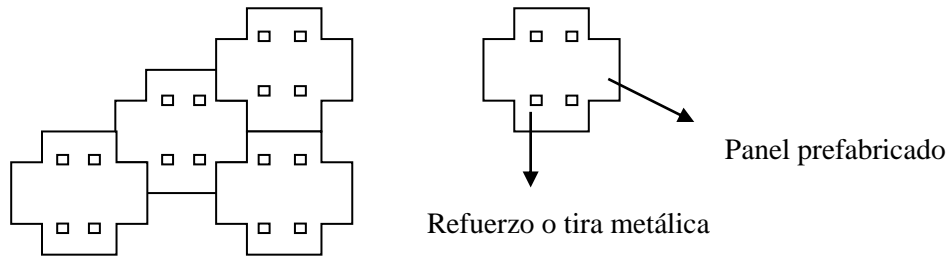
Vista frontal de los paneles prefabricados utilizados en muros mecánicamente estabilizados (FHWA, 2009)
